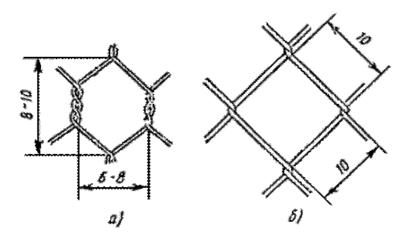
Деталь скрутки сетки габиона: а- в два оборота; б - в пол-оборота
